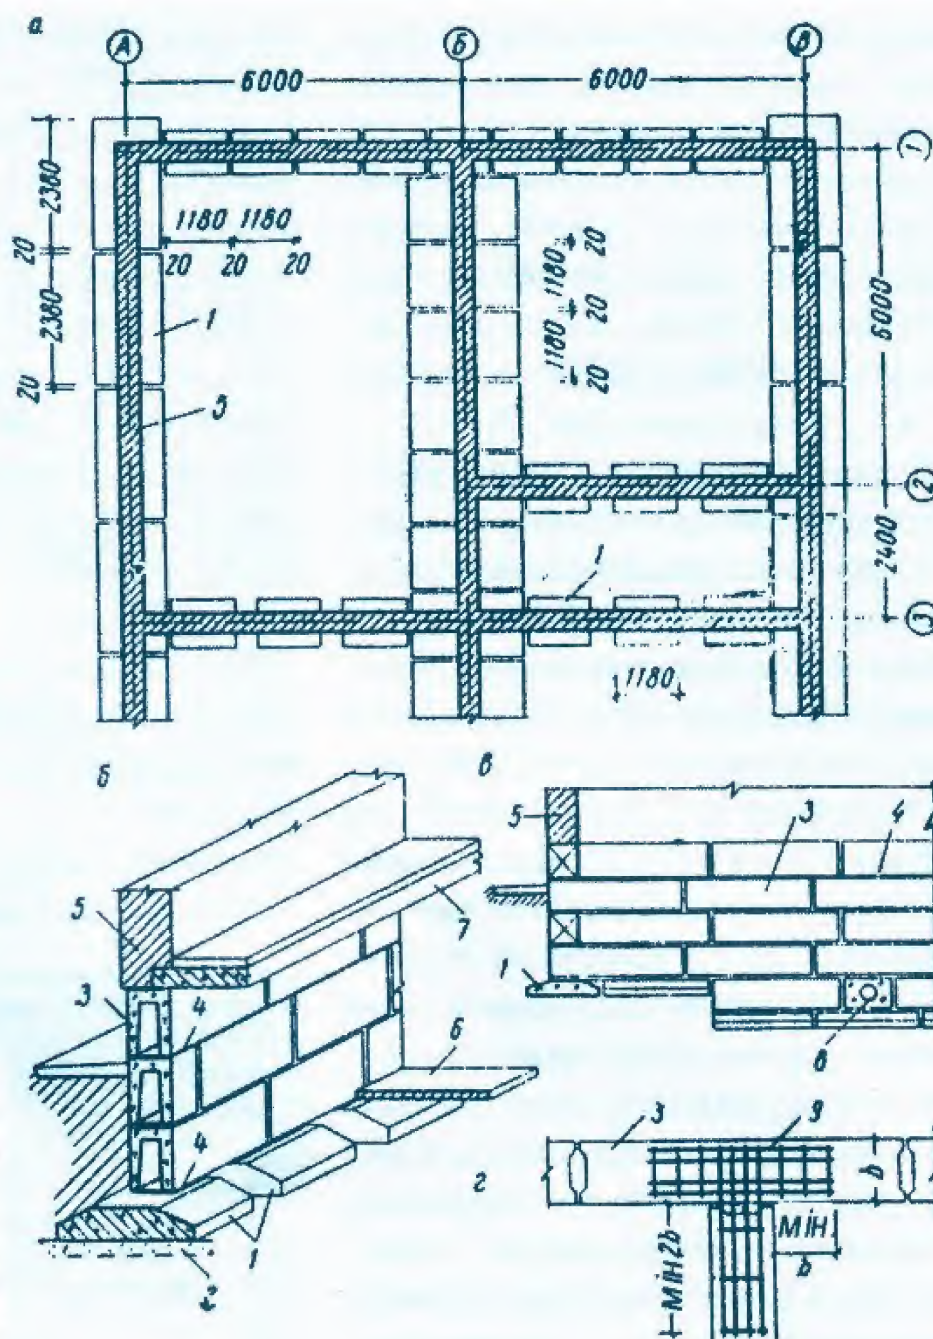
Збірні фундаменти: *а* – план переривчастого фундаменту; *б* – загальний вигляд переривчастого фундаменту; *в* – перев’язування стінових блоків; *г* – з’єднання поперечних стін із поздовжніми; *1* – фундаментні блоки-подушки; *2* – піщана основа; *3* – збірні фундаментні стінові блоки; *4* – рулонна гідроізоляція; *5* – стіна надземної частини; *6* – підлога підвалу; *7* – надпідвальне перекриття; *8* – блок з отвором під інженерні комунікації; *9* – арматурна сітка.
